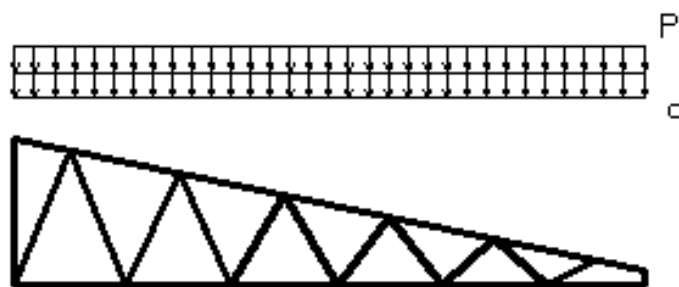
Сочетание нагрузок действующих на фермы покрытия
